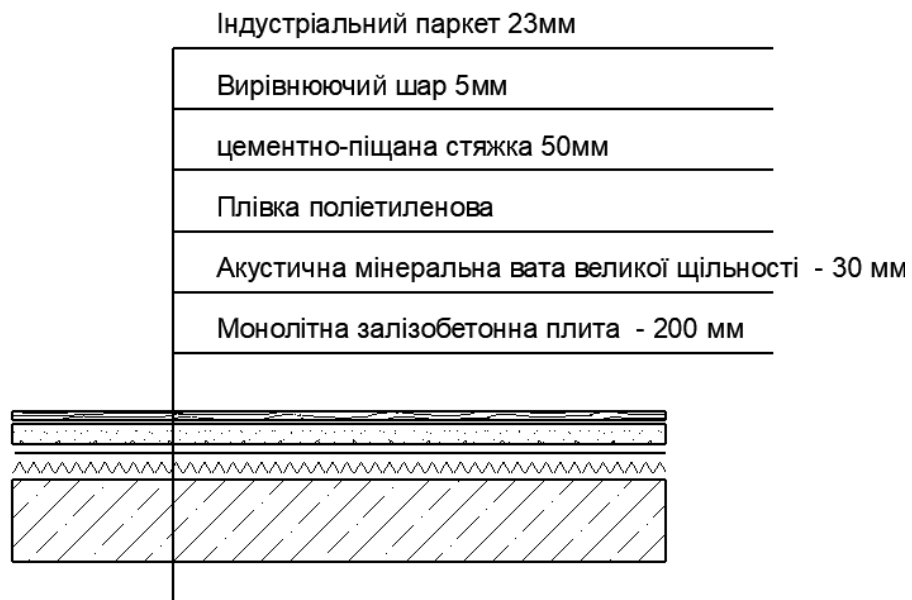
Схема міжповерхового перекриття з індустріальним паркетом
